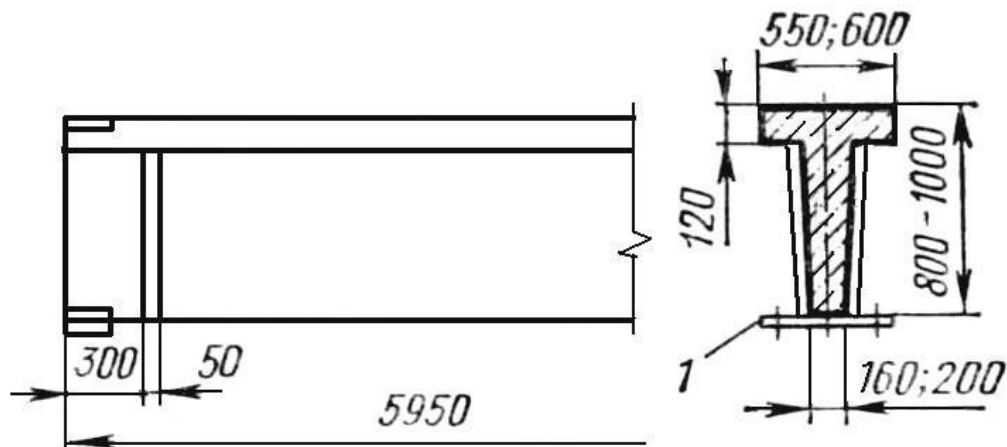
Залізобетонна підкранова балка для кроку колон 6 м
